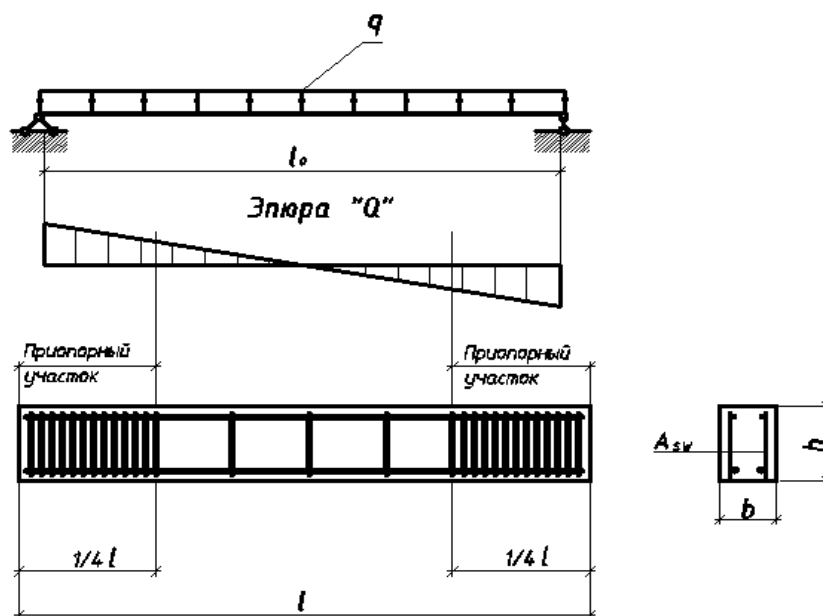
Расчетная схема балки, эпюра  $Q$  и схема армирования
